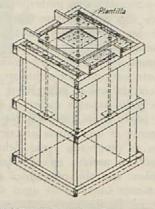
Molde para construir un apoyo para una torre o depósito elevado
